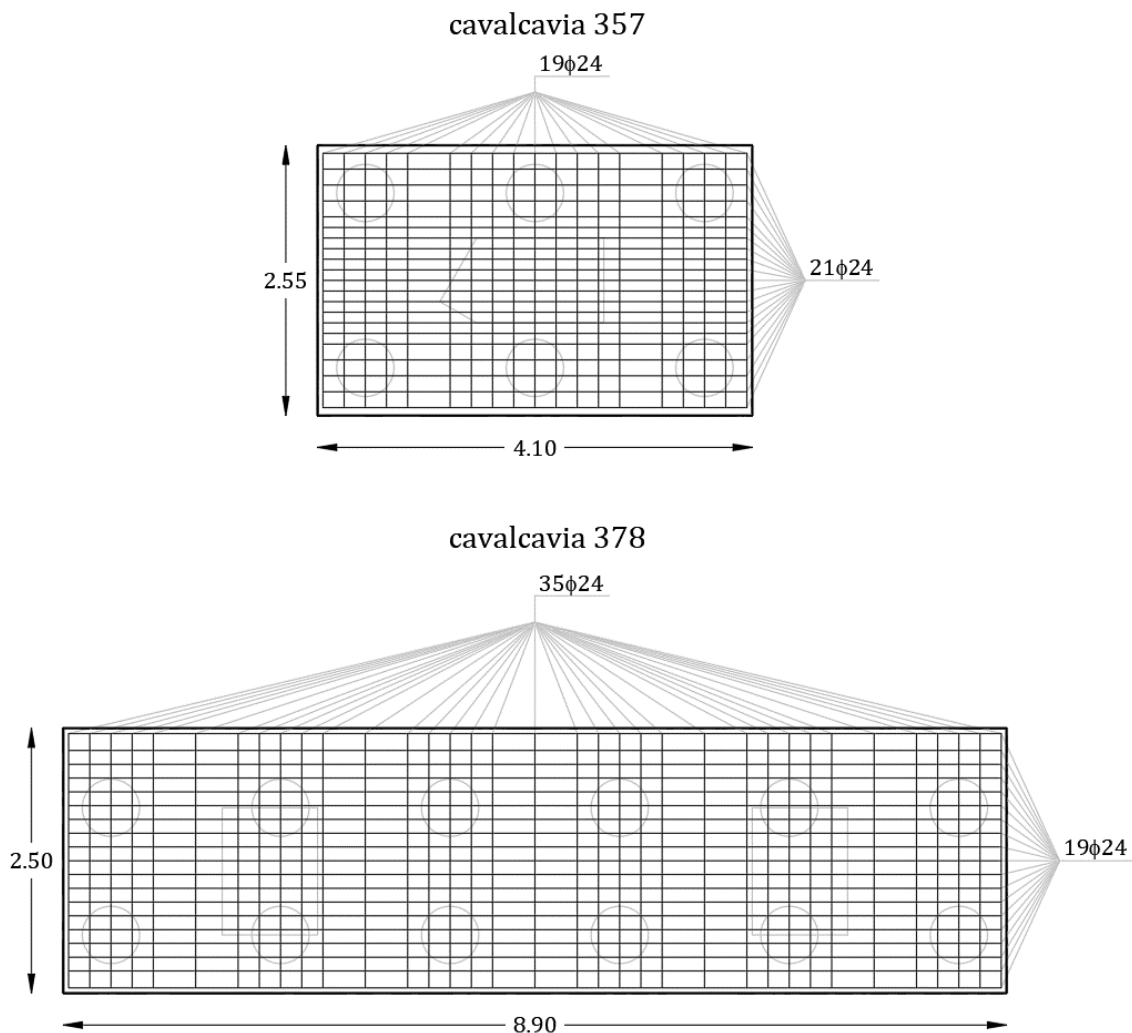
Geometria e disposizione armature plinto delle pile
